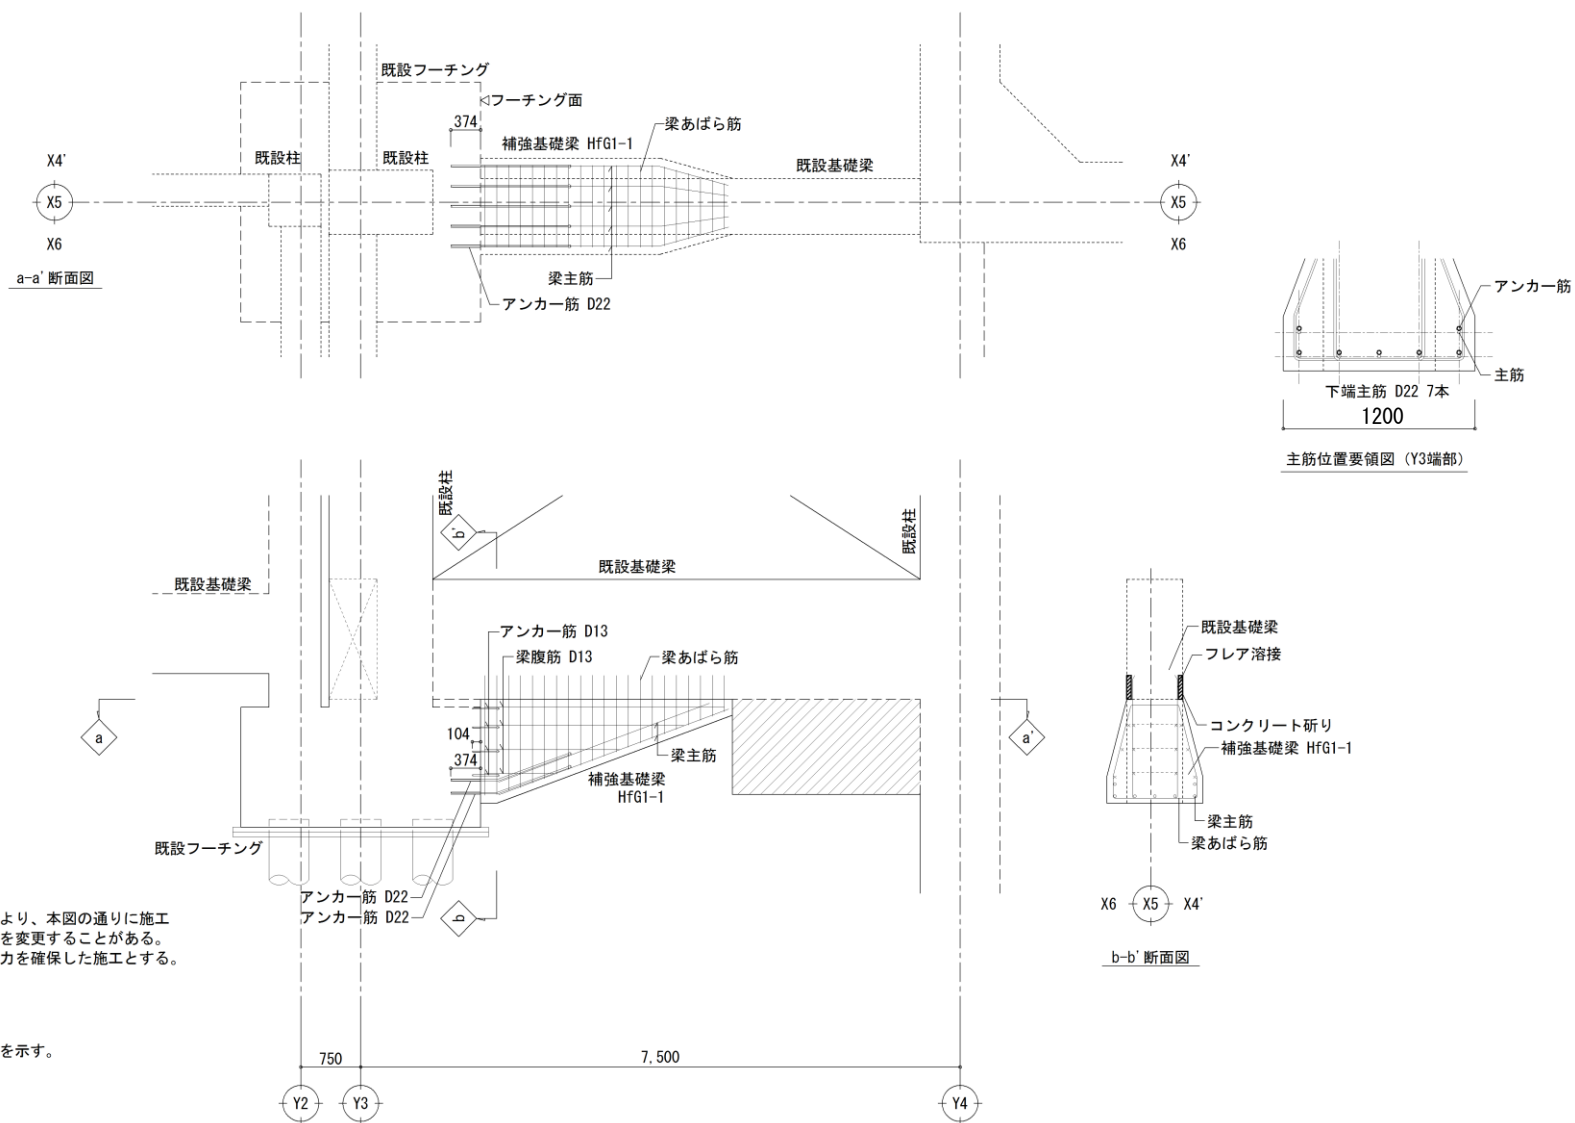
実験利用棟 X5通Y3-Y4通間 基礎梁補強配筋詳細図
